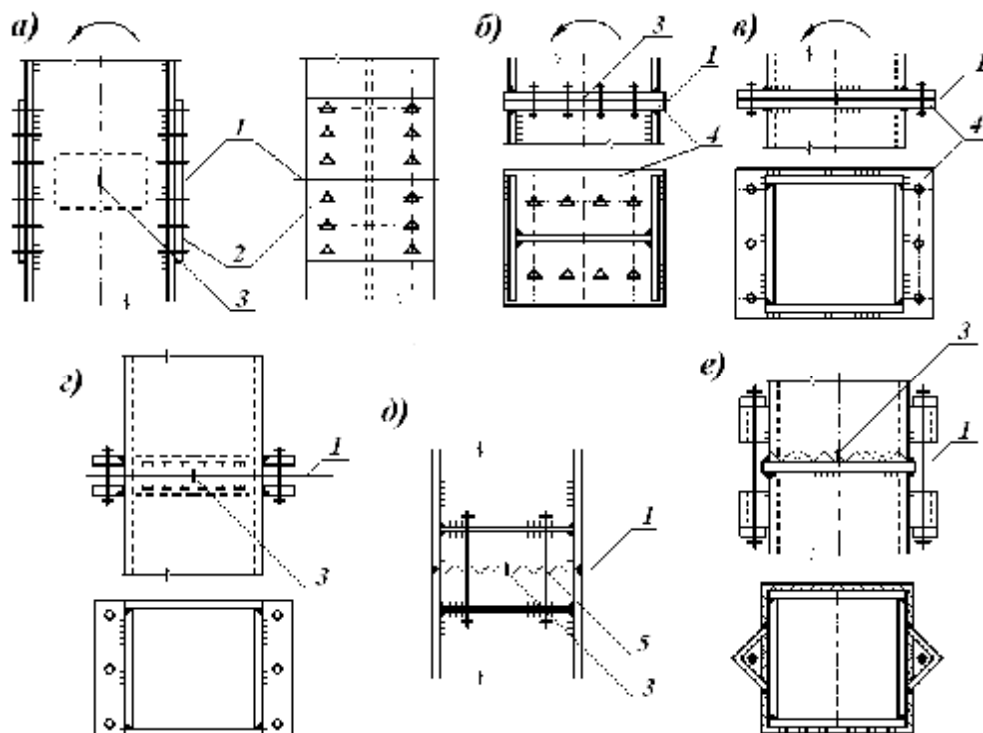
Стыки колонн при относительно больших эксцентриситетах. *а, б, в, г* – болтовые; *д, е* – сварные. *1*- плоскость фрезерования; *2*- накладка; *3*- установочная риска; *4*-фланец; *5*- установочный болт.
